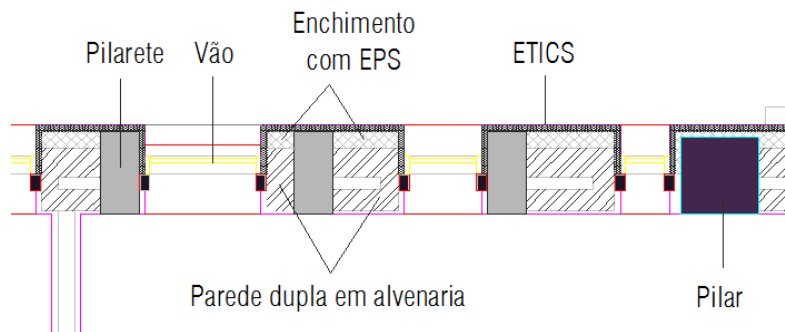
Pormenor parede de fachada - Enchimento entre pilaretes com EPS (adaptado de [10])
